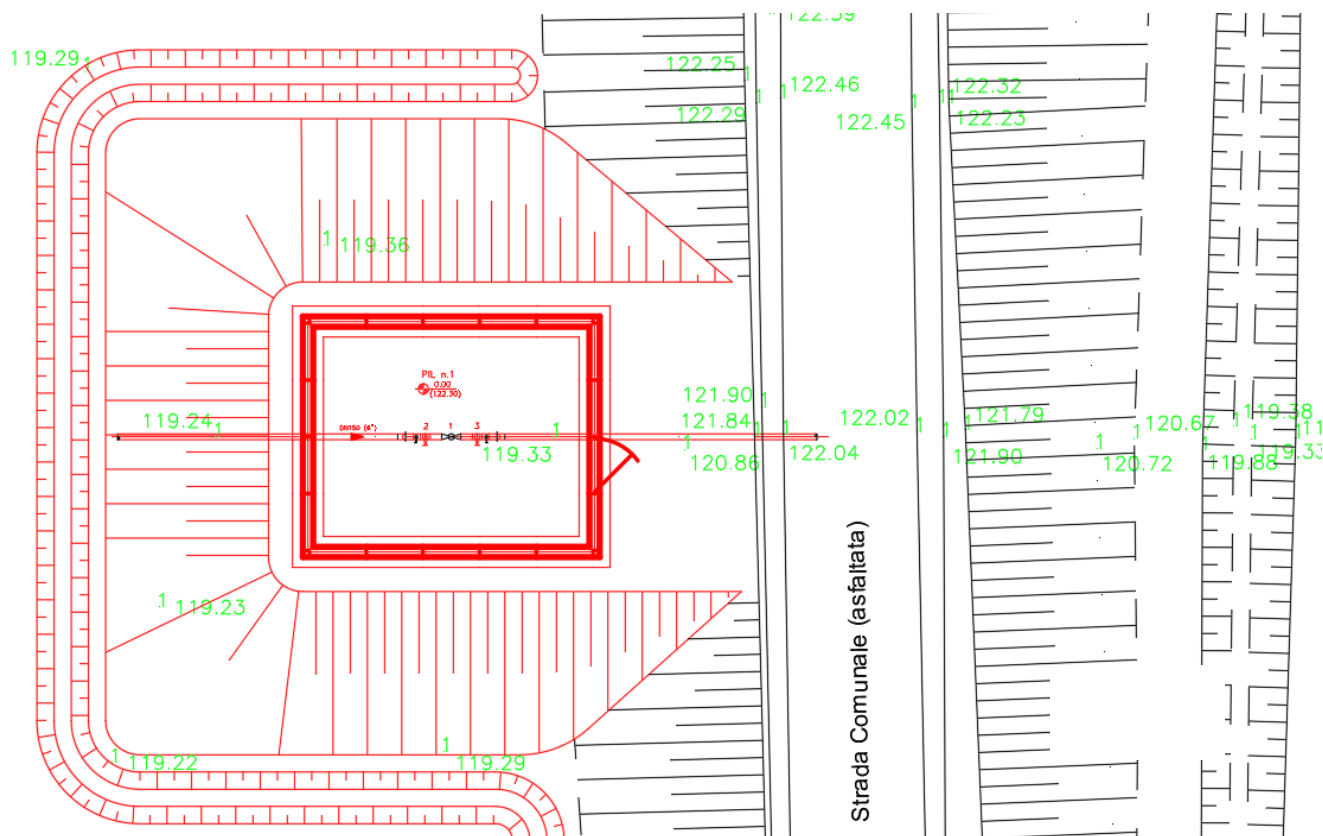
Inquadramento planimetrico delle opere in progetto.
